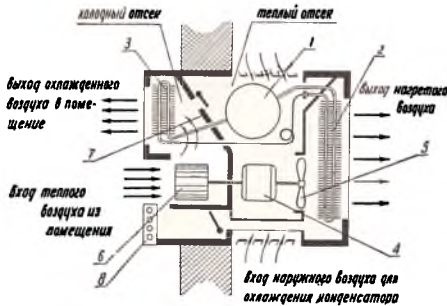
Схема устройства комнатного летнего кондиционера «Азербайджан»: 1 — компрессор; 2 — конденсатор; 3 — воздухоохладитель; 4 — двигатель вентиляторов; 5 — вентилятор осевой; 6 — вентилятор центробежный; 7 — перегородка отсеков; 8 — панель управления
